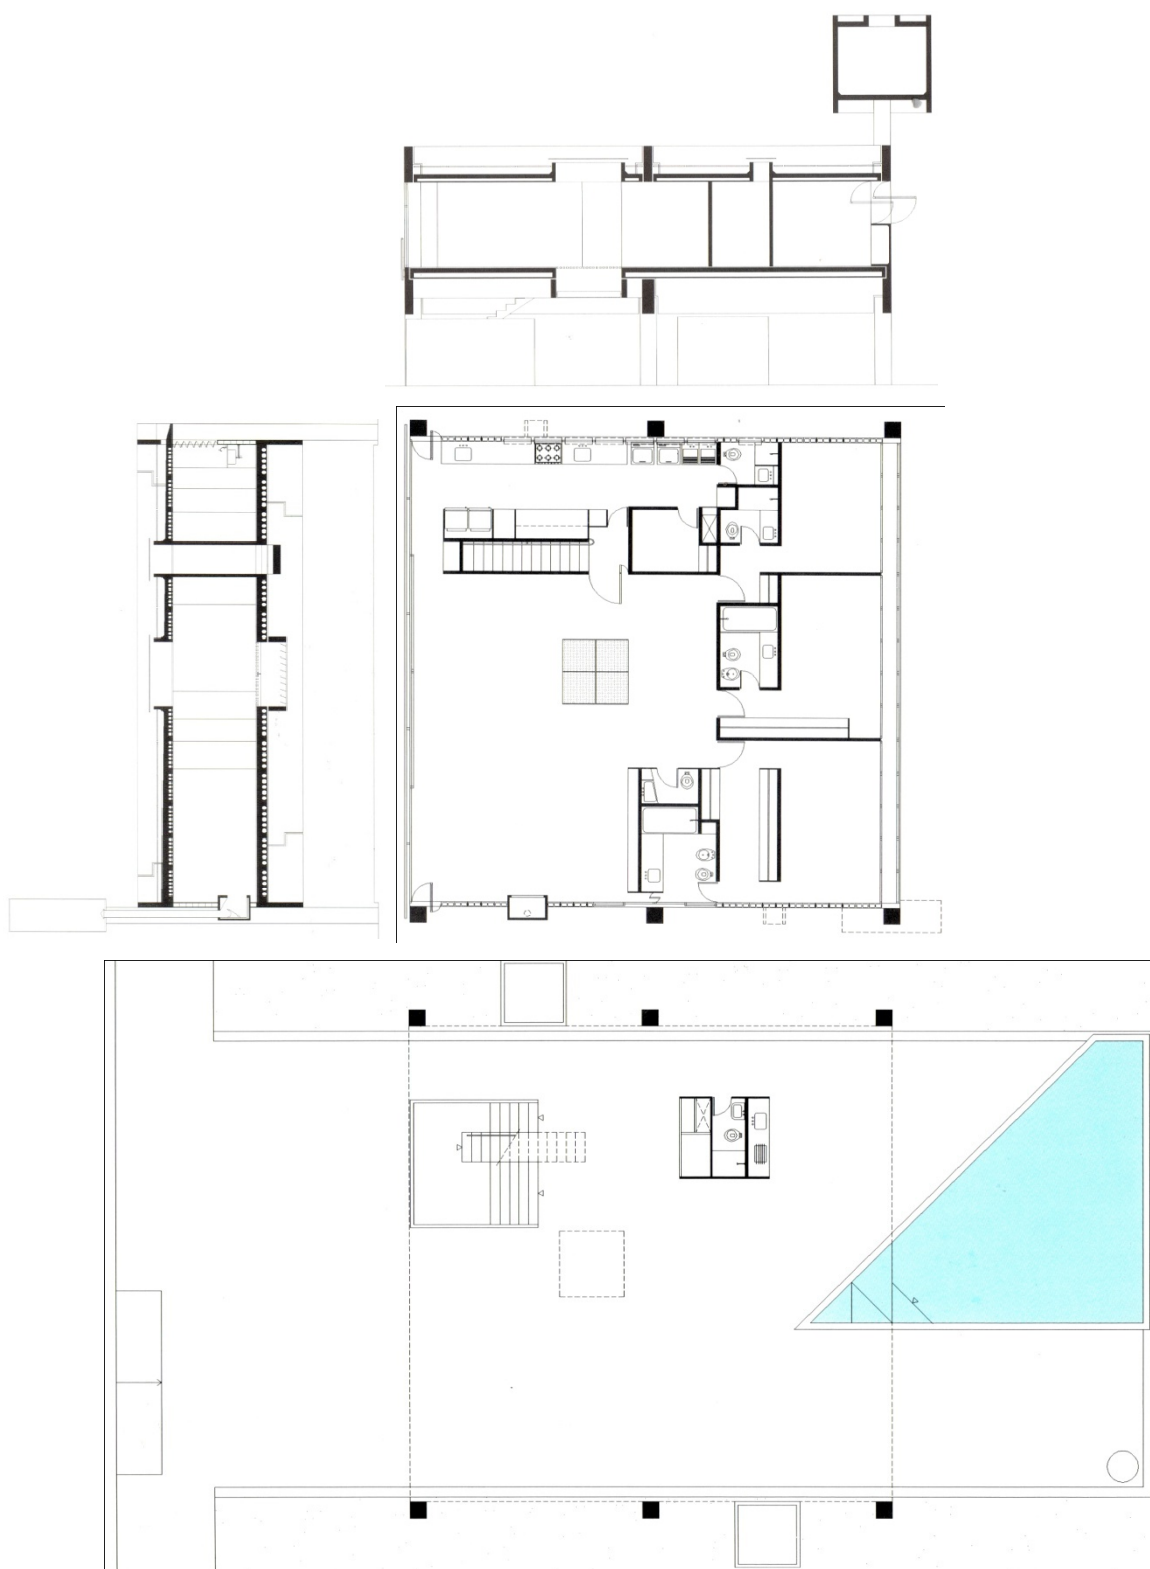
Planta piso 0, planta piso 1 e secções da *Casa Gerassi
